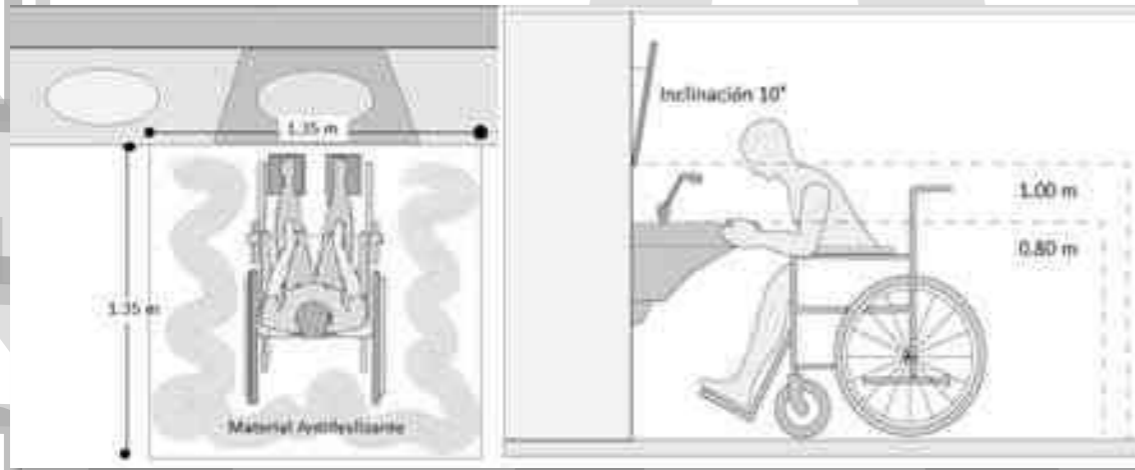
, Baño-Lavamanos en planta y alzado, Said Alberto.
